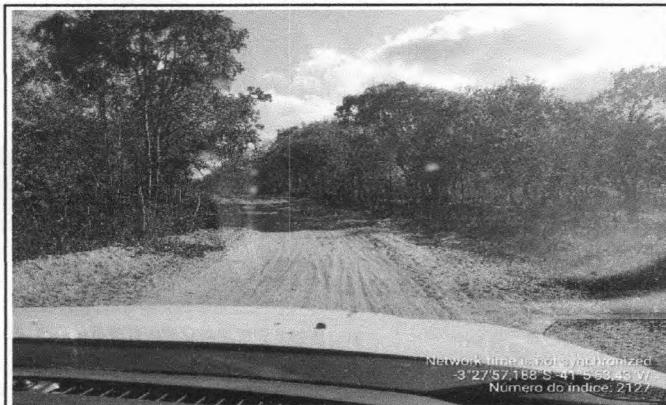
LOCAL DA CONSTRUÇÃO - BUEIRO
